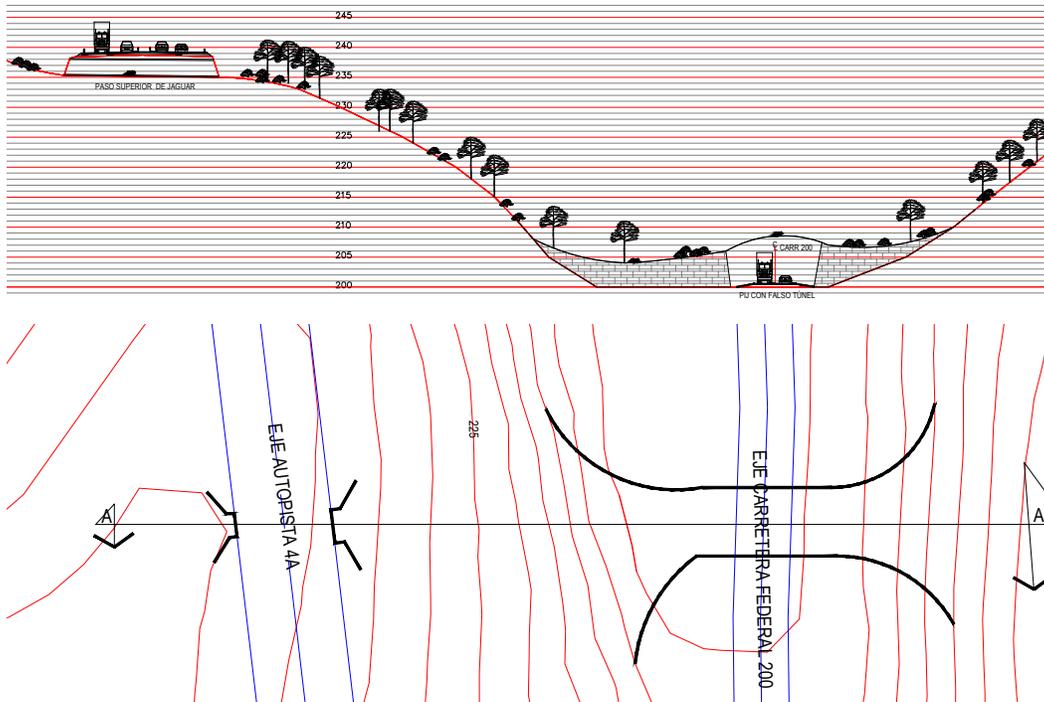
Paso inferior de Jaguar – Planta y Sección de cruce en el proyecto
